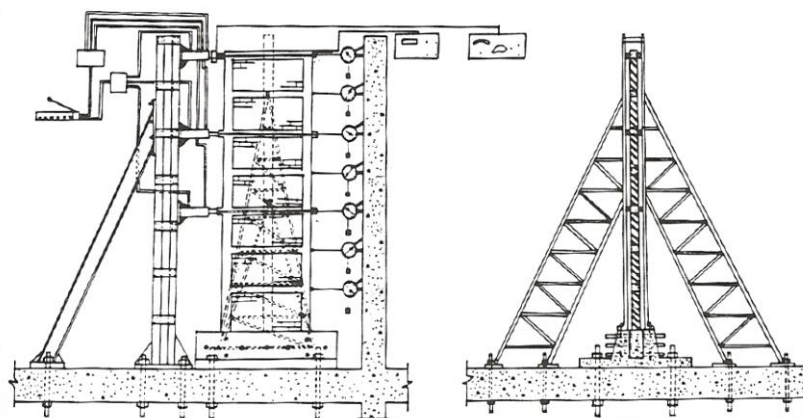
Dispositivo de ensaio de um pórtico preenchido com paredes de alvenaria de tijolo à escala 1:4 [55, 56].
